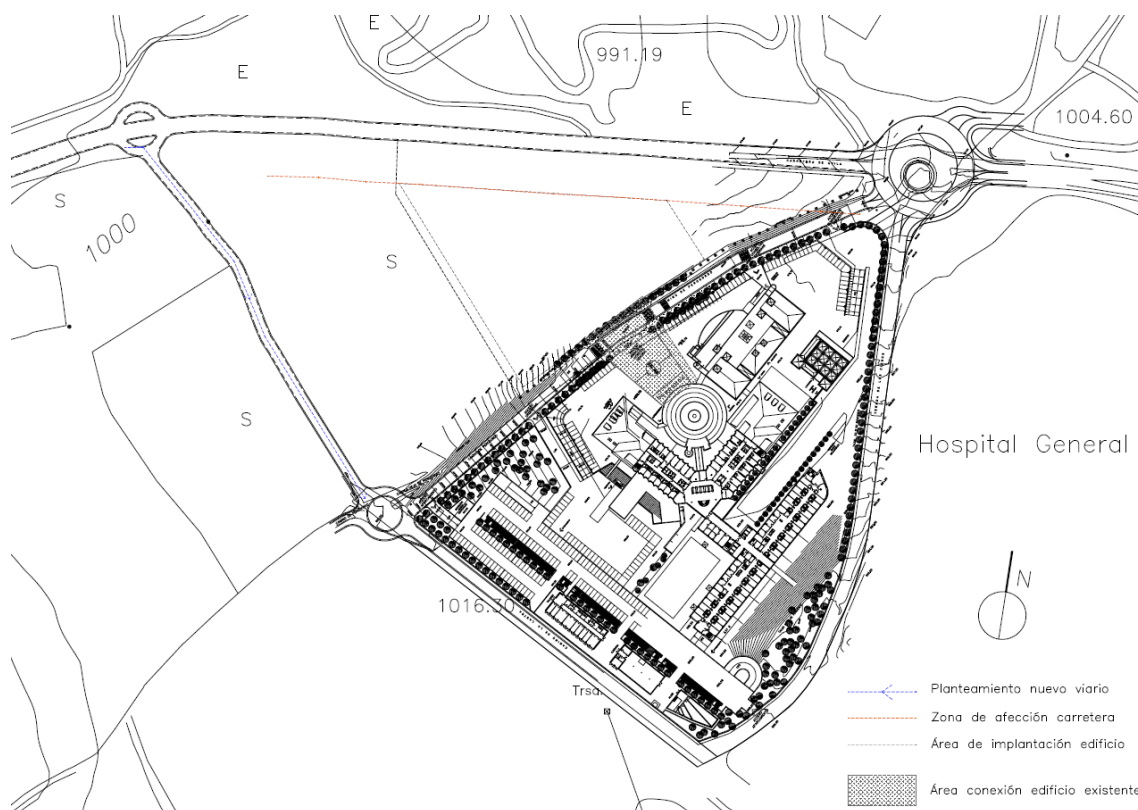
Planta detallada del Hospital General de Segovia en su estado actual
